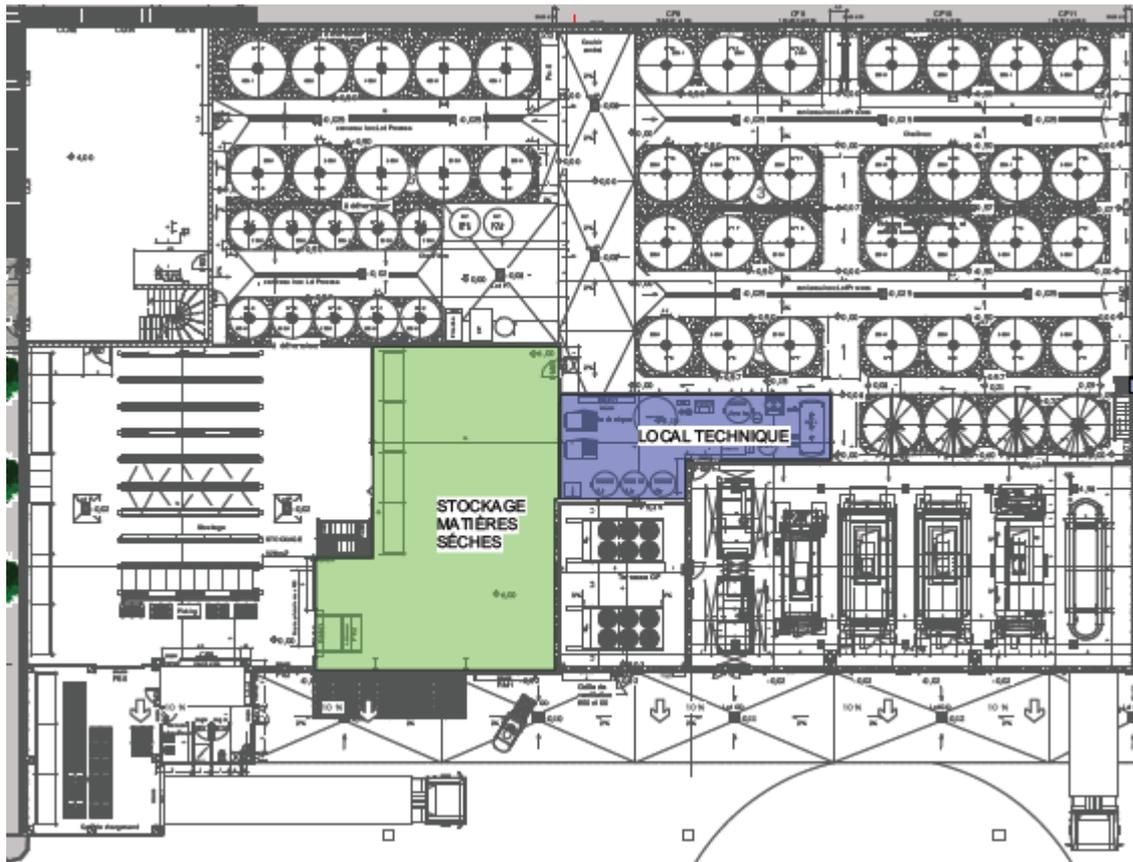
Plan de masse du Chai Existant – Niveau R+1
